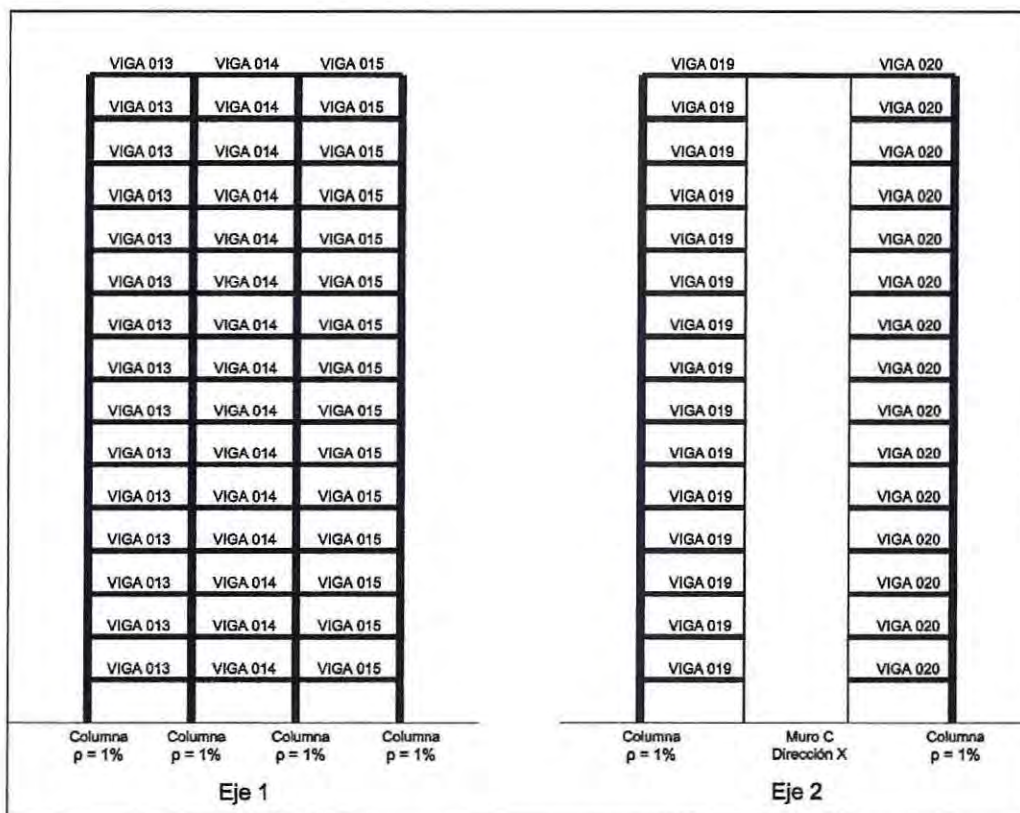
Distribución de vigas en estructura mixta, ejes 1 y 2.
